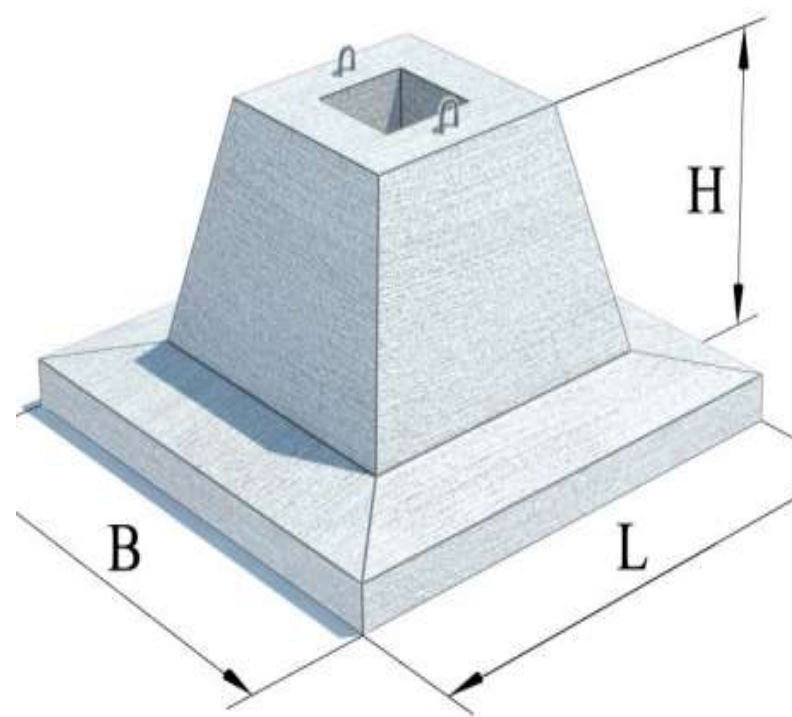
Отдельно стоящие фундаменты под железобетонные колонны
